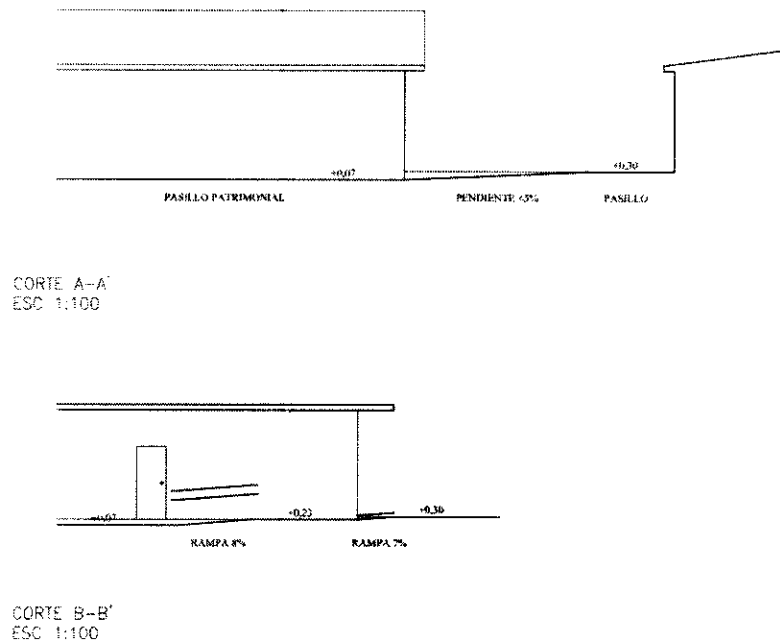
Planimetría Situación Propuesta – Edificio Consistorial
